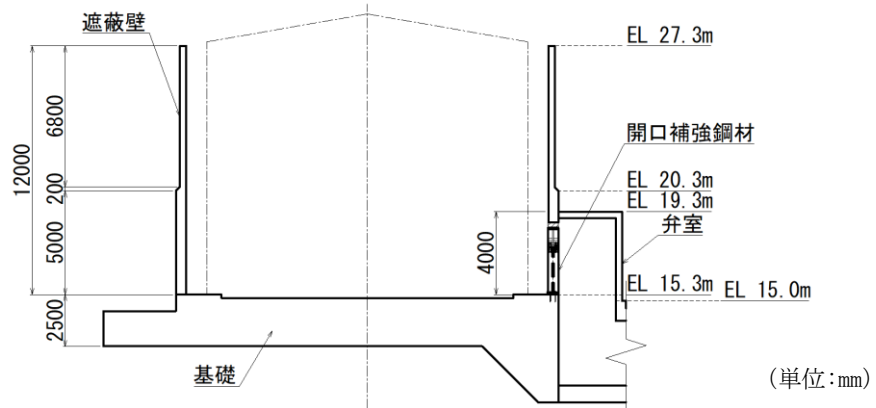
復水貯蔵タンク遮蔽壁 断面図 (A-A 断面, 東西)
